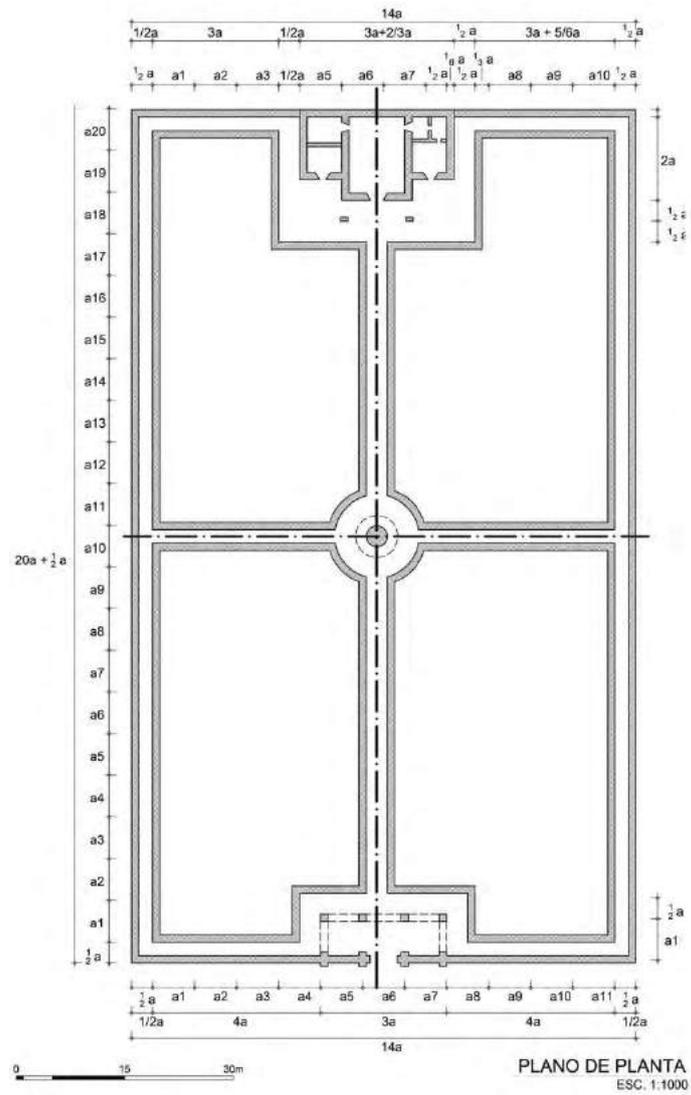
Plano de modulación de la planta del modelo hispano de cementerios extramuros de 1804. Elaboración propia.
